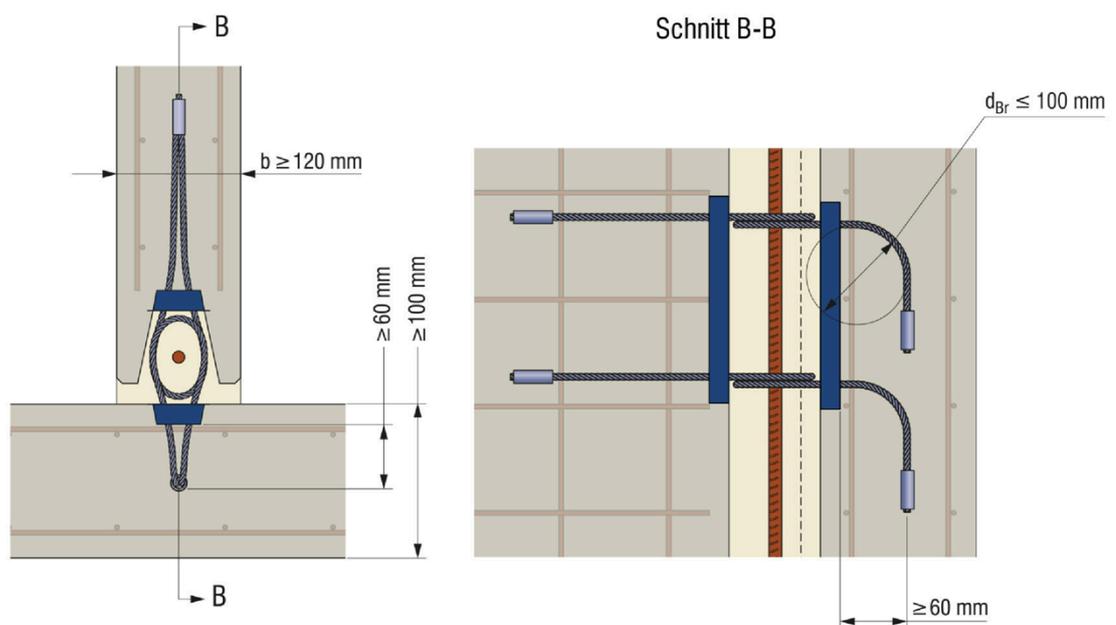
Wand – Wand – T-VERBINDUNG - Detail mit abgewinkelten Seilschlaufen
